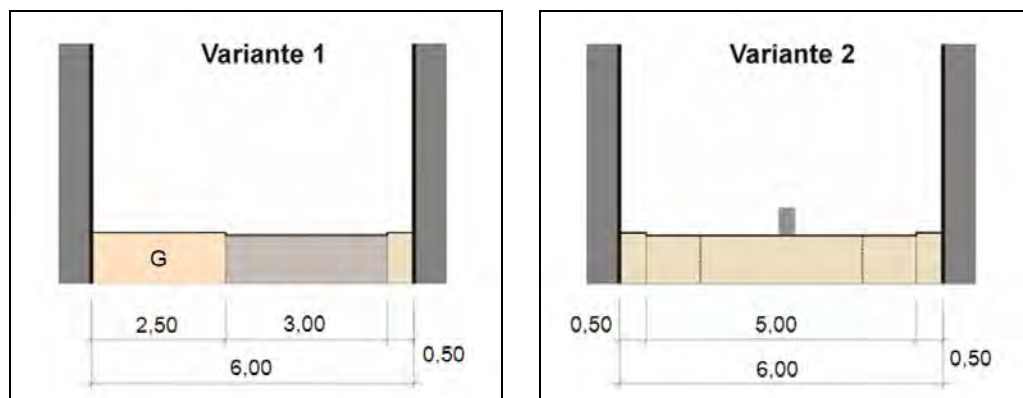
Umbauvarianten der Kaltensondheimer Straße
